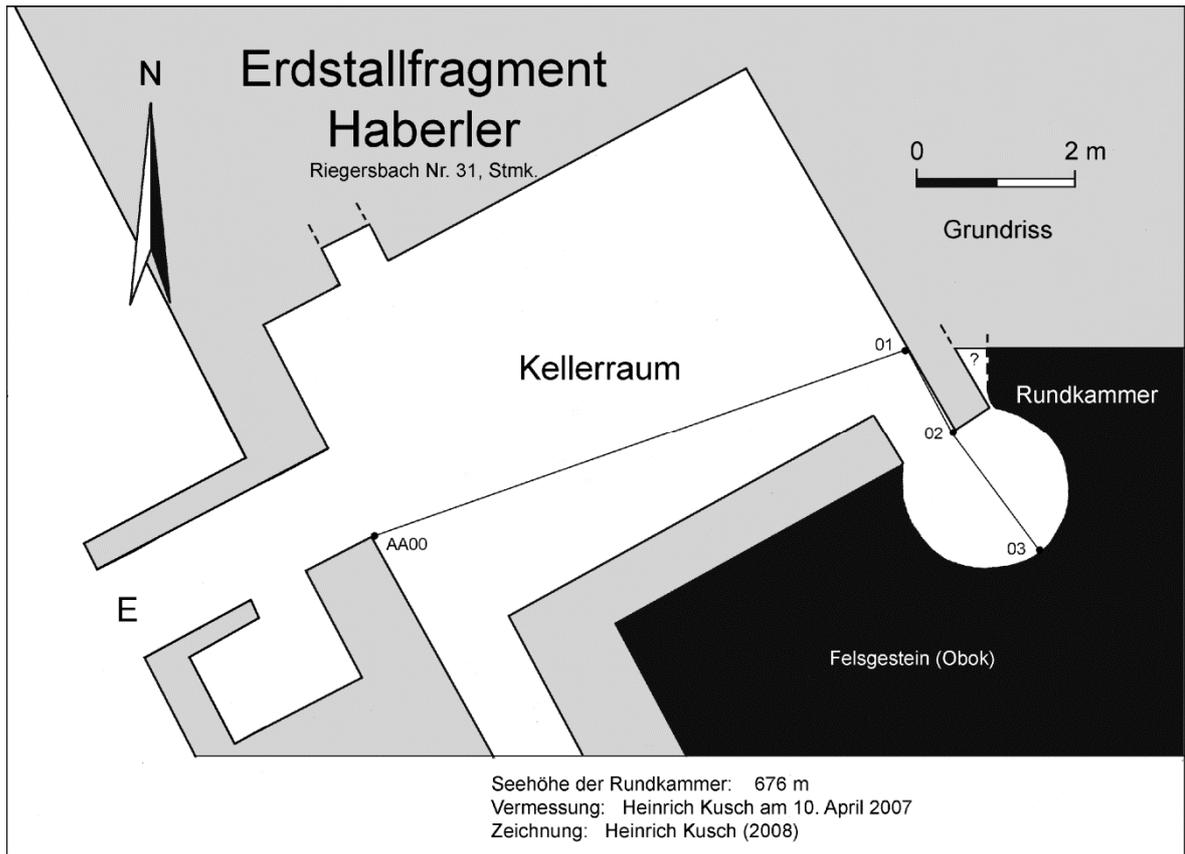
Grundrissplan eines Erdstallfragmentes (Rundkammer) im Kellerraum des Haberler-Hofes, der zu den ältesten Gehöften aus dem Mittelalter im Raume Vorau zählt.
